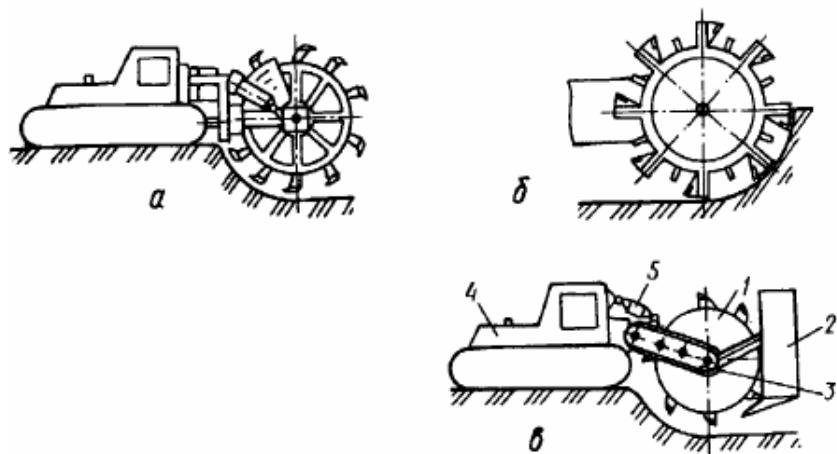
Роторні розпушувачі: а - щілинно-фрезерна машина ЩФМ-3-08; б - навієнс розпушувальне обладнання зі змінною шириною робочого органу; в - роторно-метальний агрегат РМ-2 (1 - фреза; 2 - металевник; 3 - рама; 4 - трактор; 5 - гідроциліндр)
